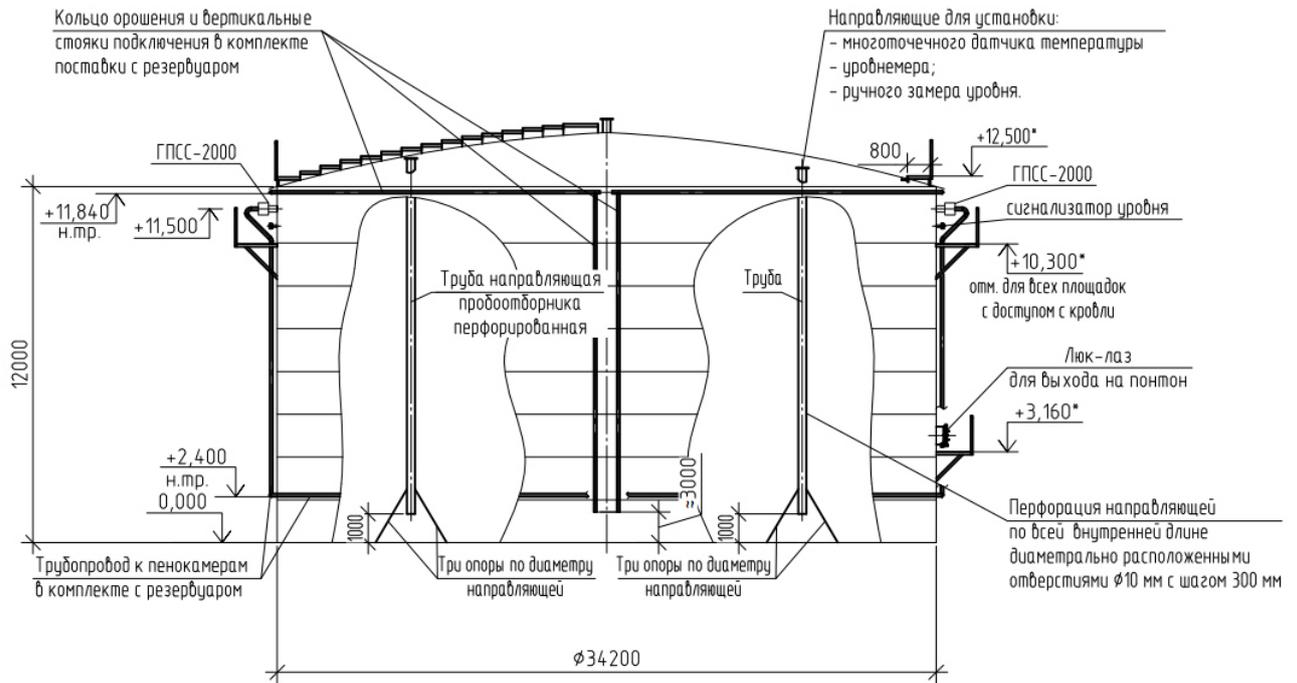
Размещение трубопроводов установки пенного пожаротушения и водяного охлаждения стенки резервуара, площадок обслуживания и т.д.
